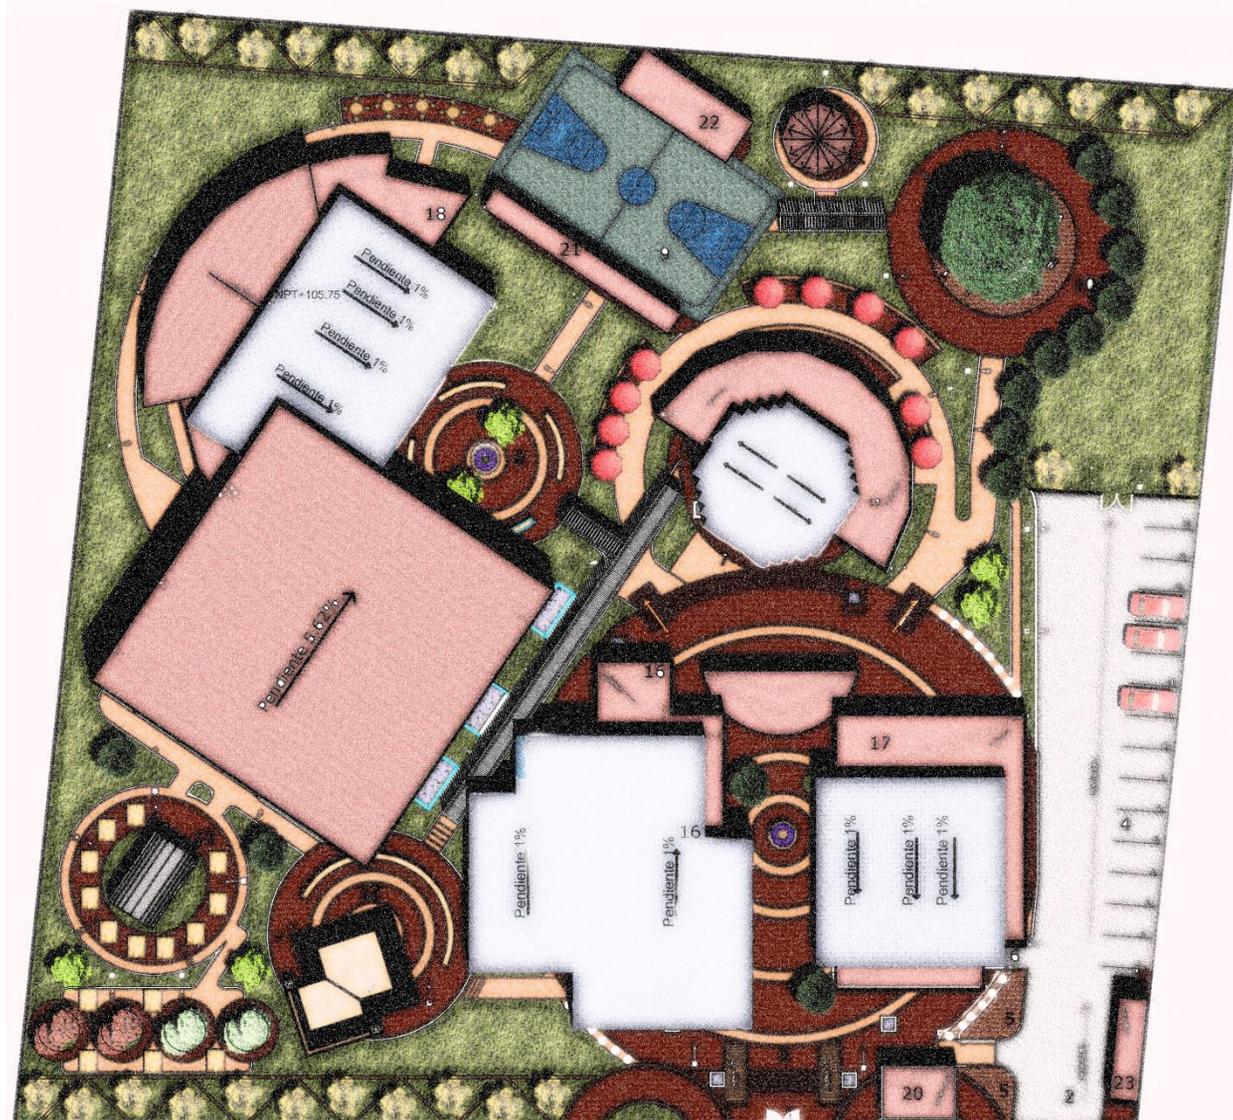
Ilustración II.XIII Planta de cubiertas ambientada. Fuente. Elaboración propia.
